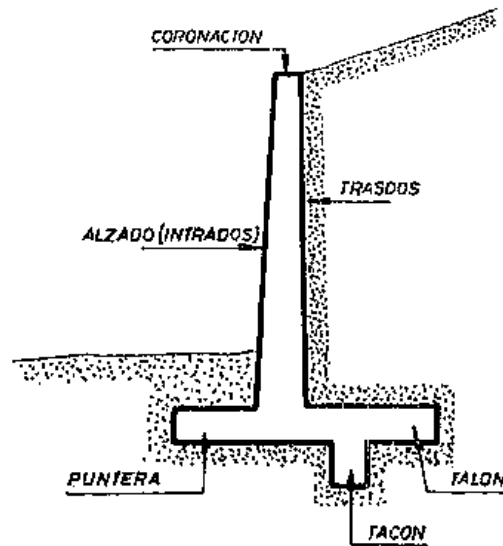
Tipo clásico de muro de concreto armado (Barros; 1974: 12)
